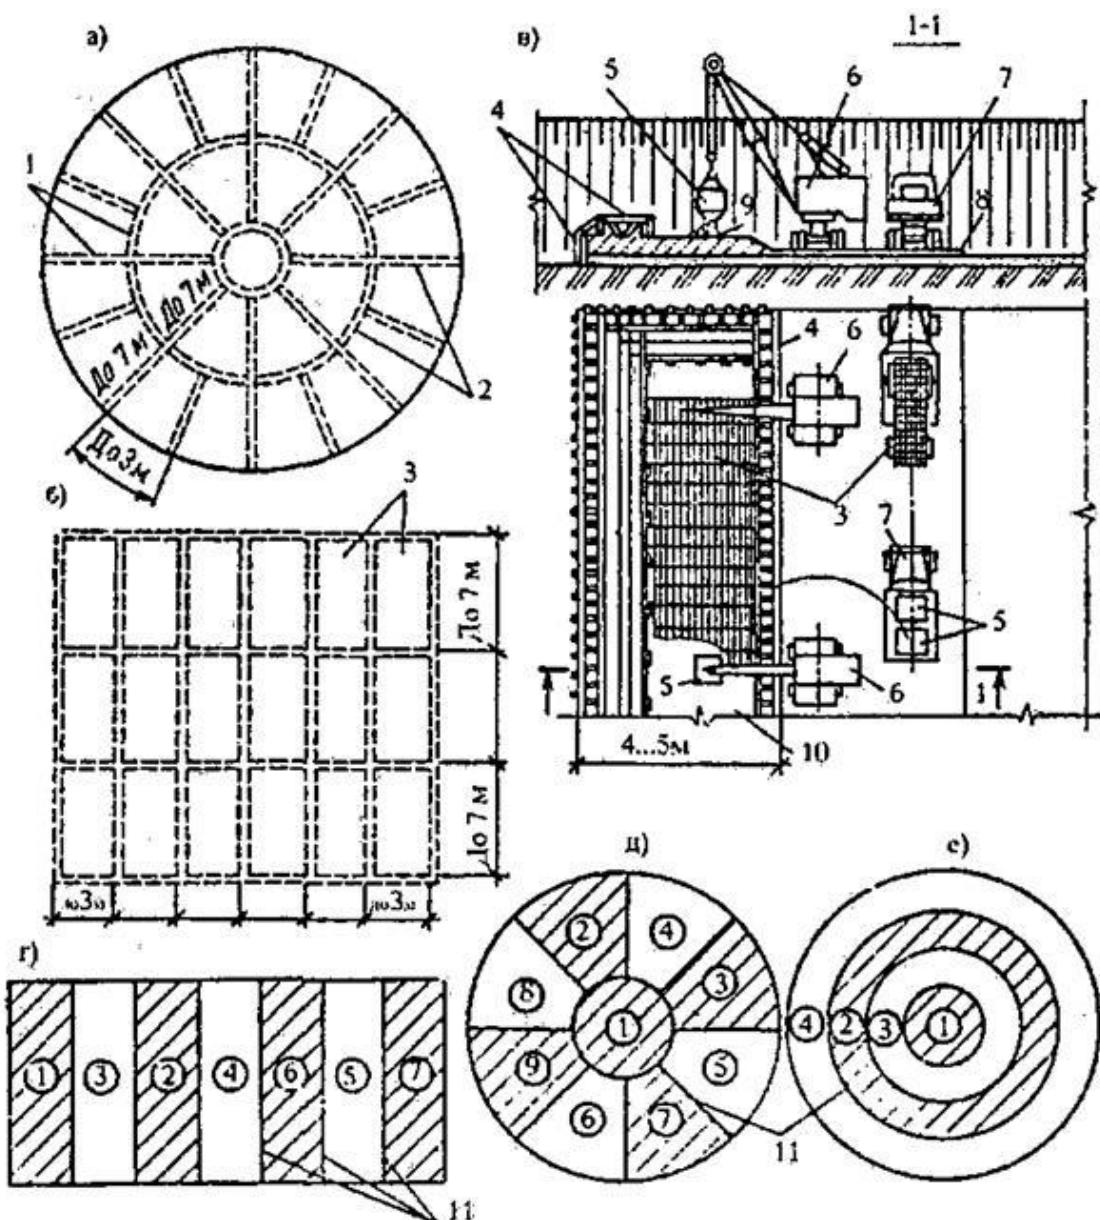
Схема организации бетонных работ при устройстве днища емкостных сооружений:
